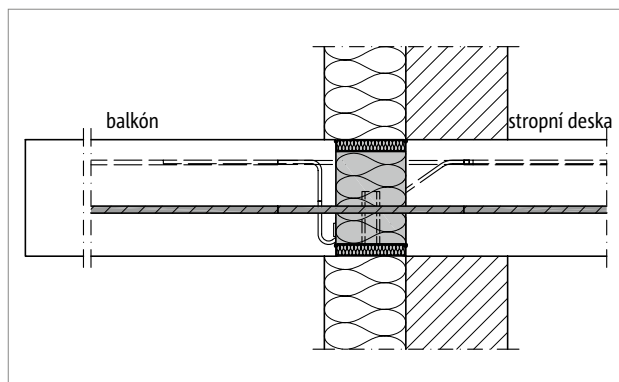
Schöck Isokorb® XT typ HP: Volně vyložený balkón
